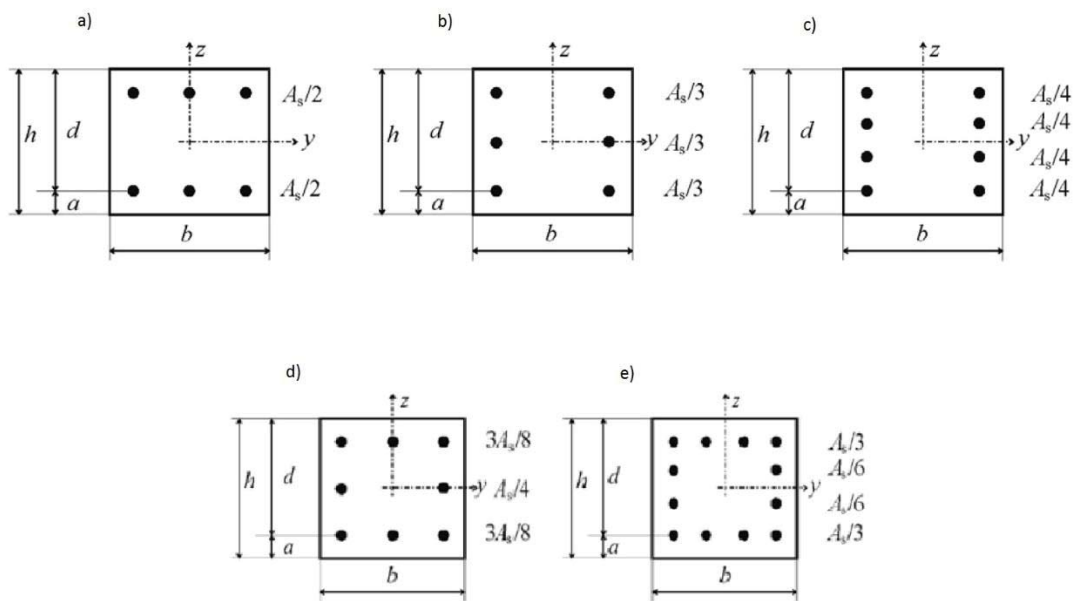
5 disposições de armaduras em secções retangulares
